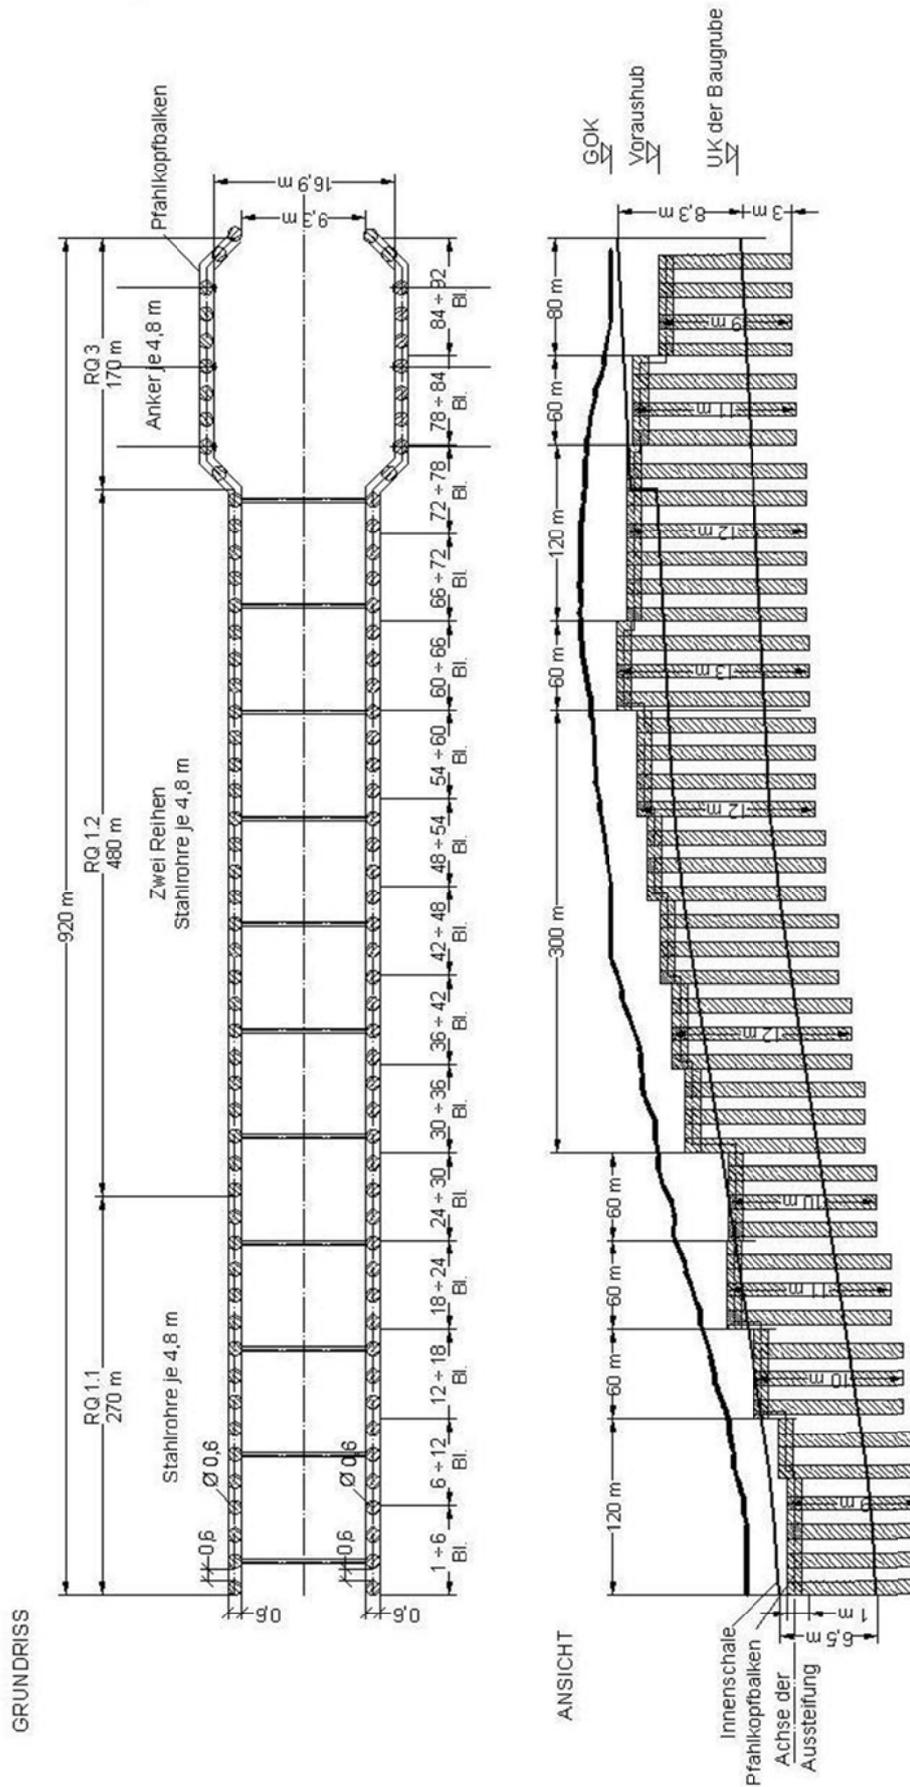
Grundriss und Ansicht des gewählten Bauloses (überhöht)
